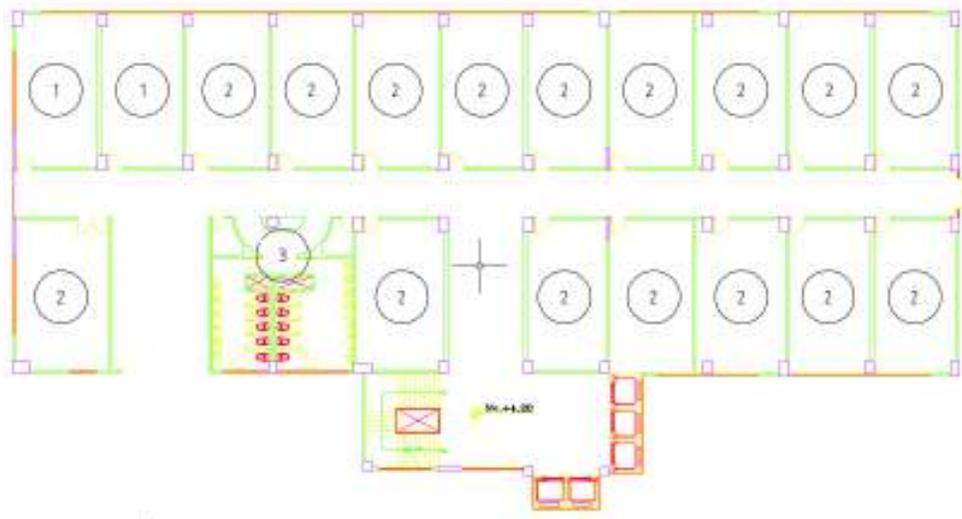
Distribución EARME primera etapa, Planta Primer piso
